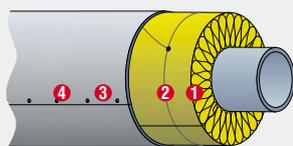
1. Цилиндр ROCKWOOL, 2. Крепежная проволока 3. Защитный кожух 4. Заклепки либо винты.
